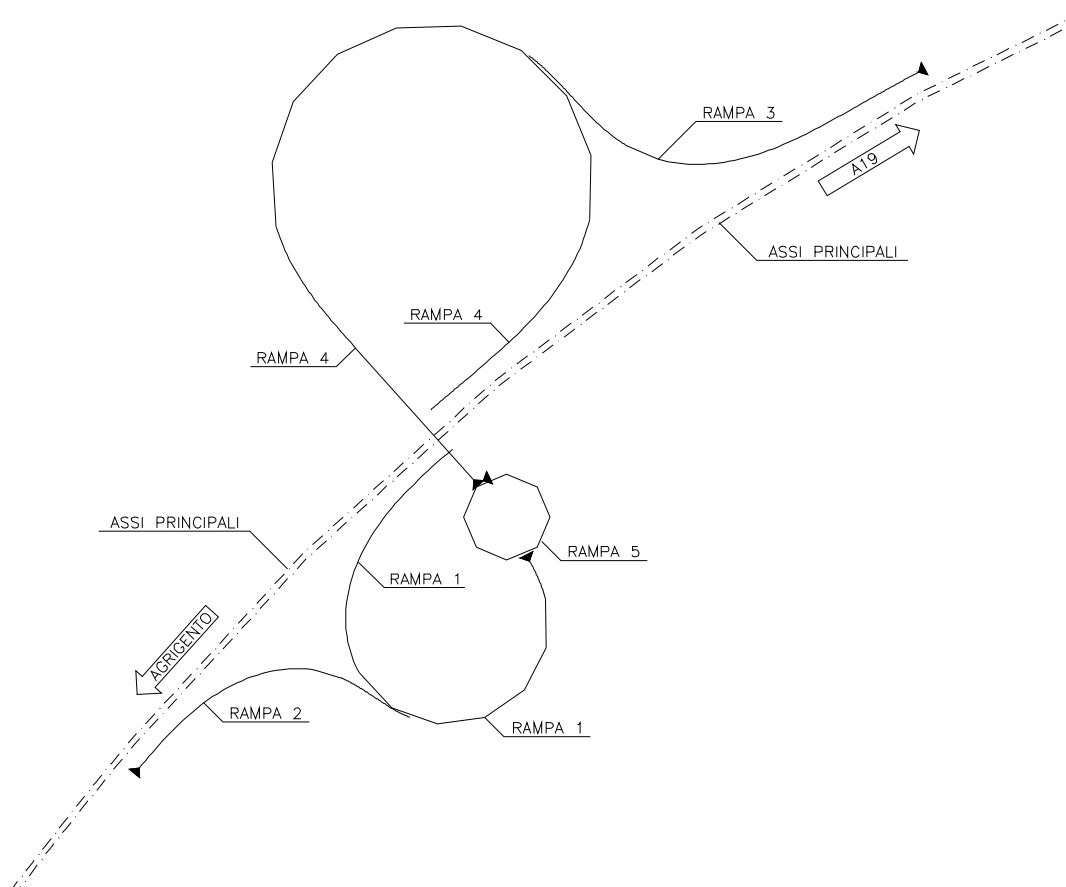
Svincolo Caltanissetta nord- Planimetria schematica
